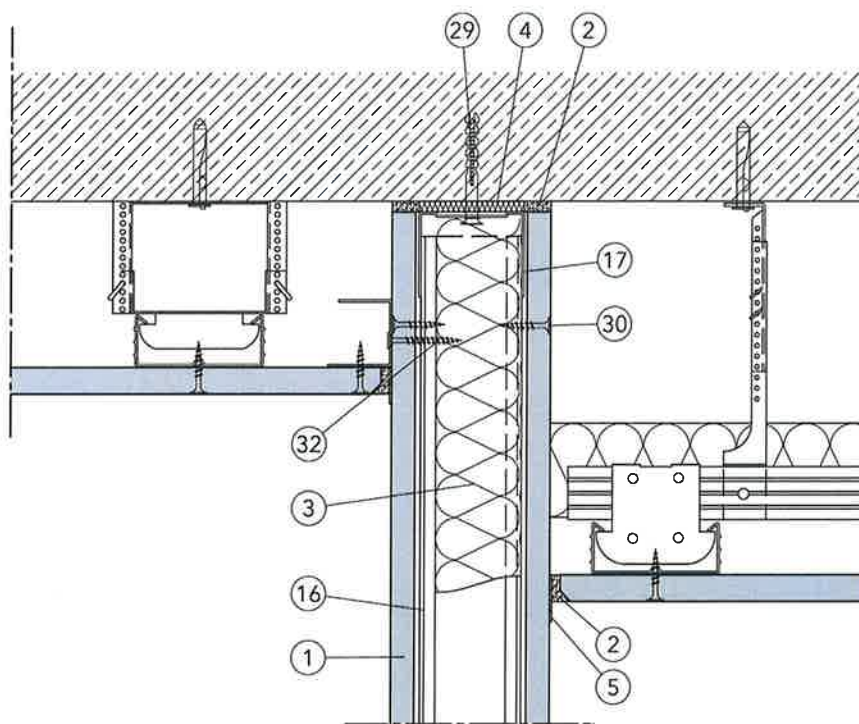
Starrer Deckenanschluss an Massivdecke u. unterbrochener Unterdecke
